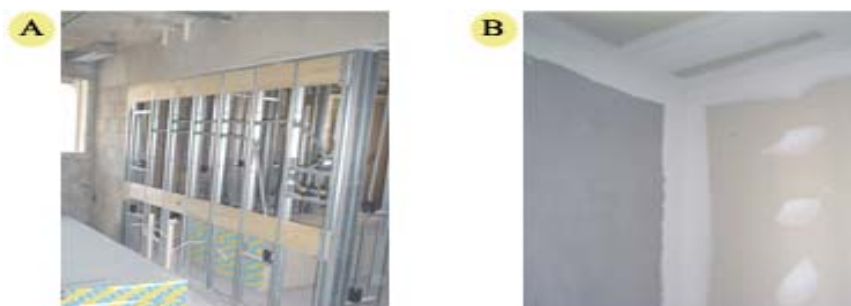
Encontro entre parede *dry-wall* e parede de alvenaria
